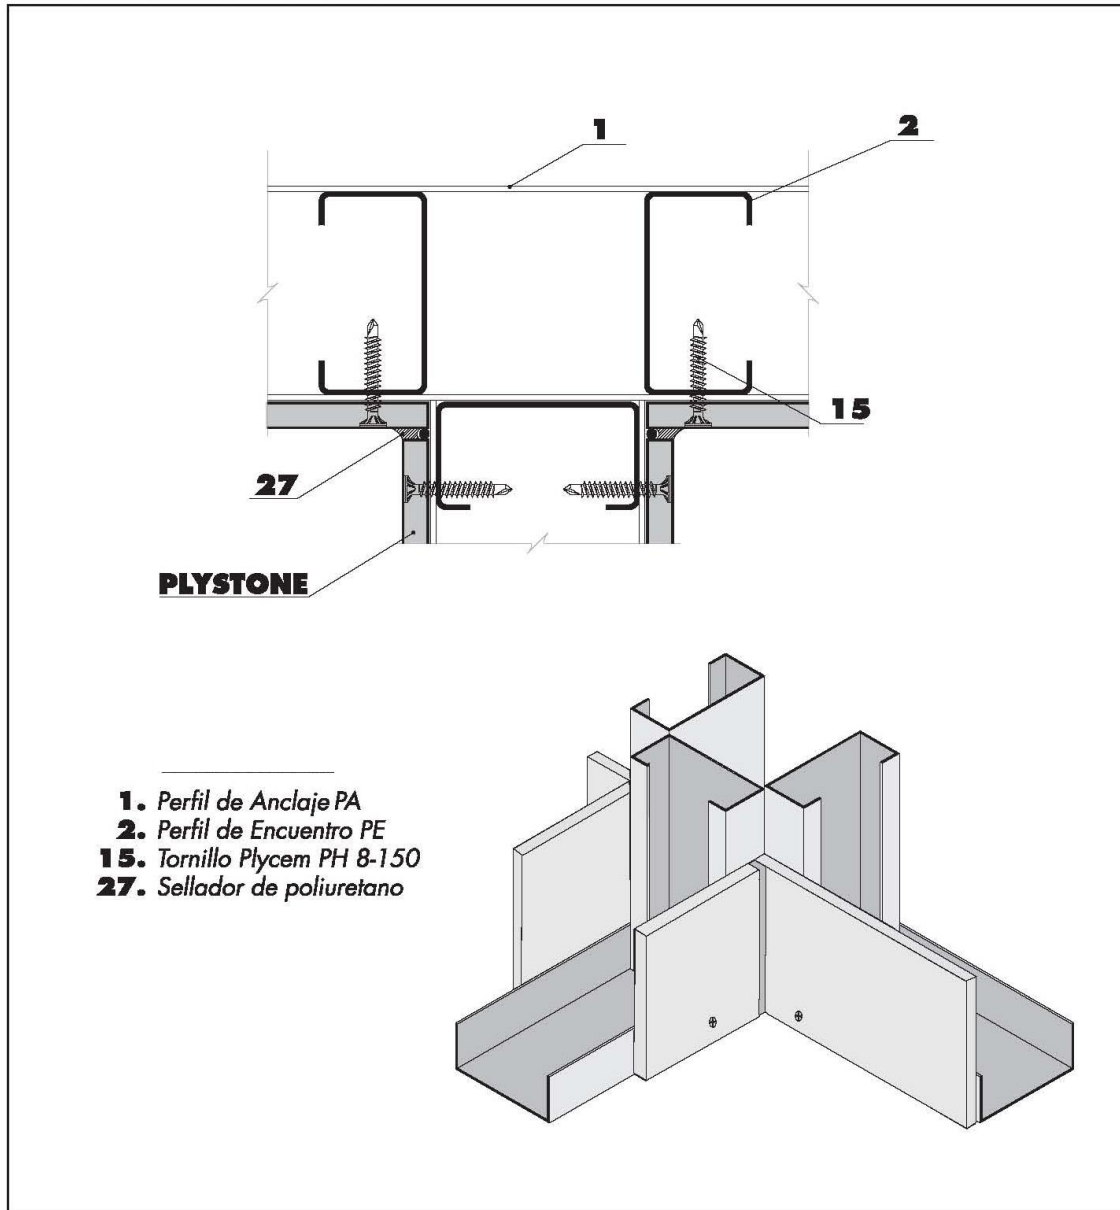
Detalle 10. Paredes exteriores. Fijación de láminas Plystone. Encuentro de muros en T [87].
